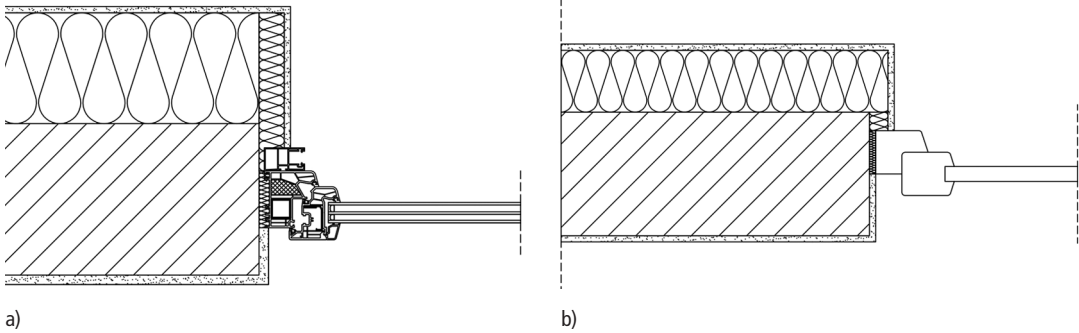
Gegenüberstellung der realen Ausführung des Laibungsanschlusses mit Führungsschiene (a) mit dem bisherigen Detail nach [8] (b)
